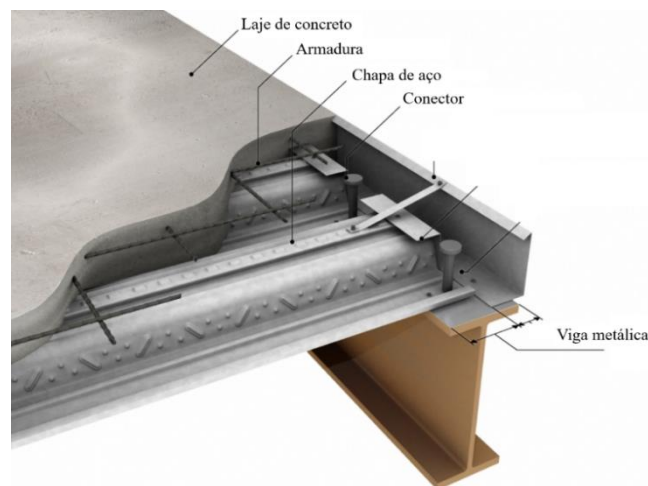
Sistema misto com *steel deck* (adaptado de MPIL STEEL STRUCTURES, 2021).
